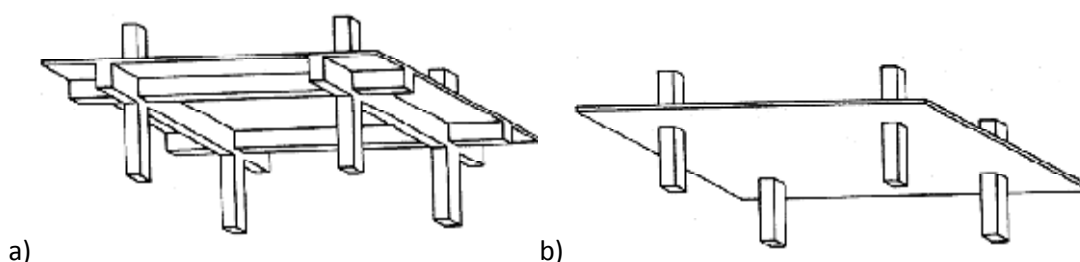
Sistemas de apoios de lajes: a) laje apoiada em vigas, b) laje apoiada em pilares (Cachim, 2005)
